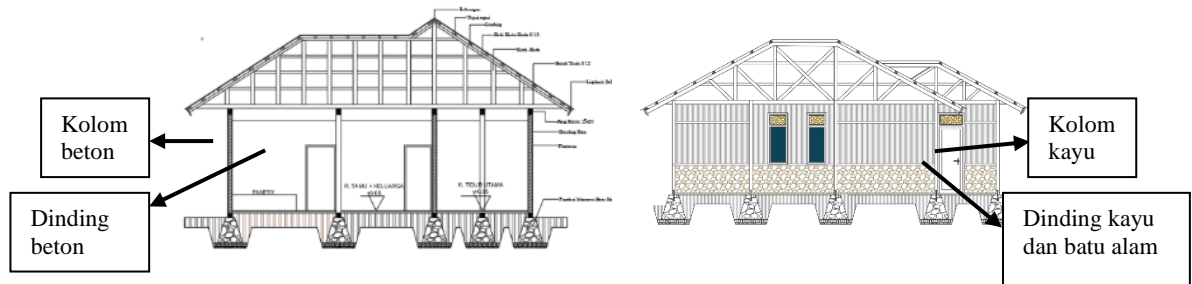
14 konsep Sub Struktur, Pondasi umpak dan Batu
